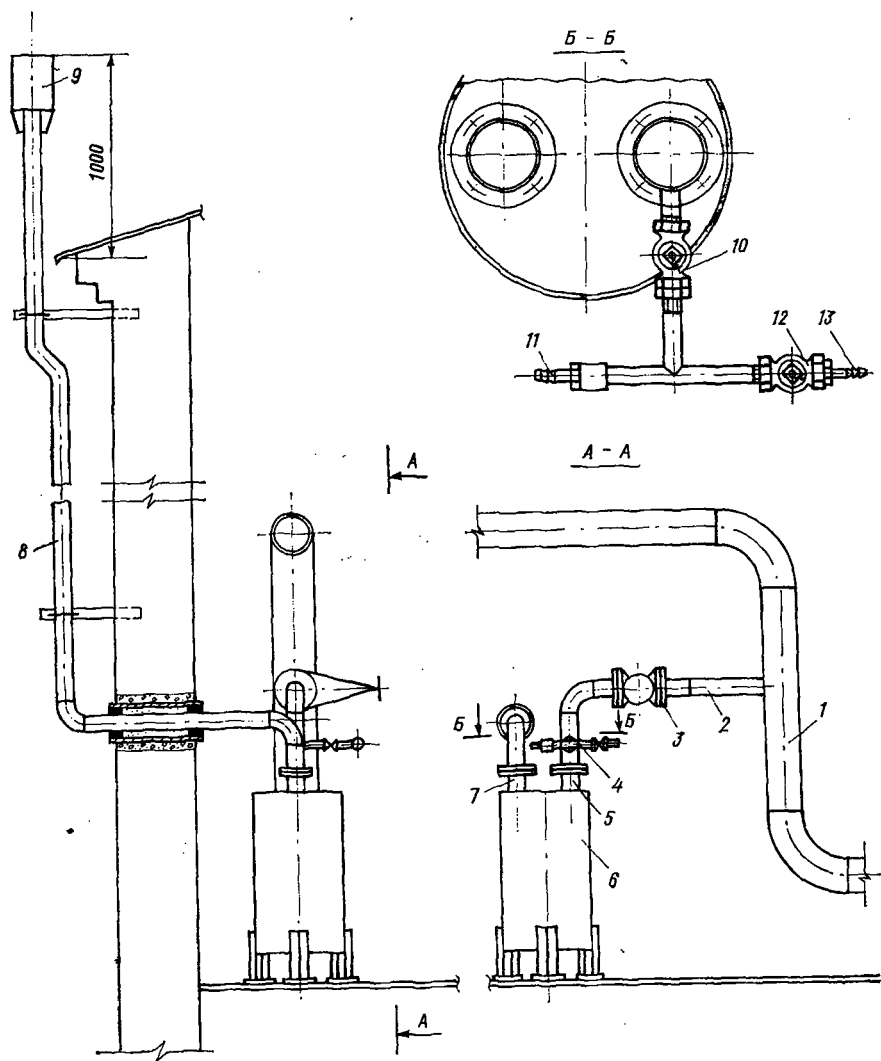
Установка гидравлического предохранителя с приспособлением для его настройки.
